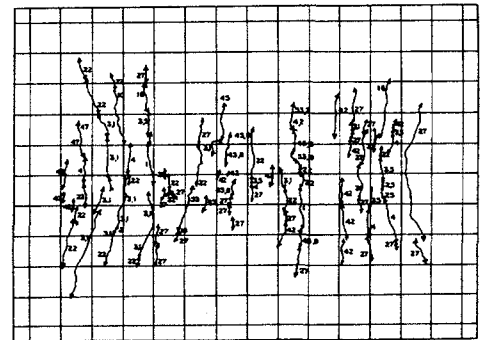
最終ひびわれ状況(試験体 II、単位: 万回)
